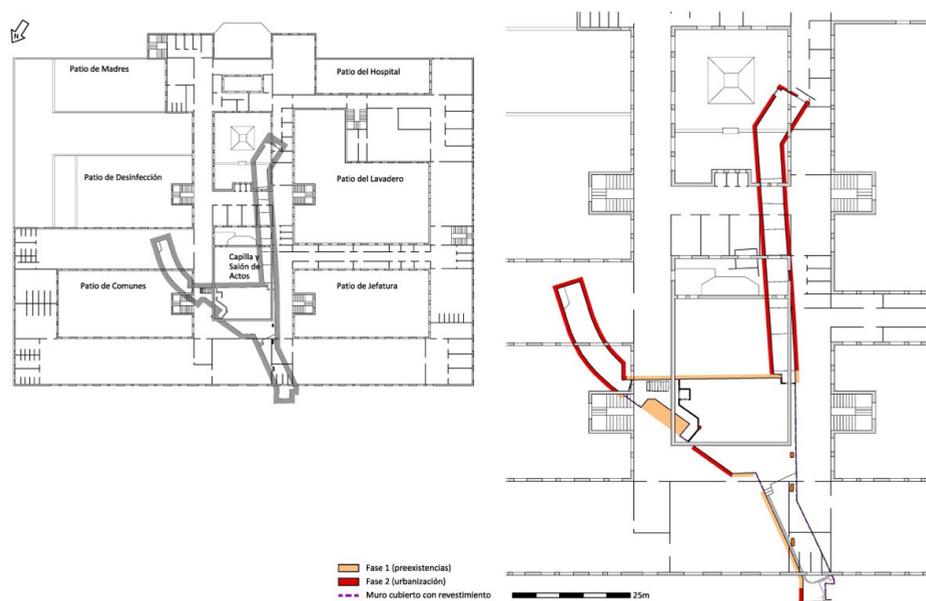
Planta de las galerías subterráneas superpuesta sobre la planta de la cárcel. (Dibujo de los autores).
